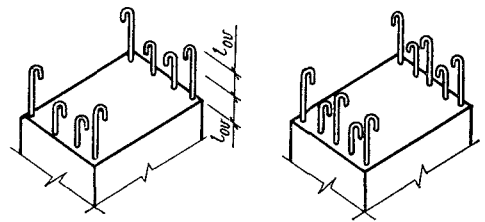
Расположение выпусков гладких стержней для устройства стыков арматуры фундамента с арматурой колонны внахлестку без сварки.
